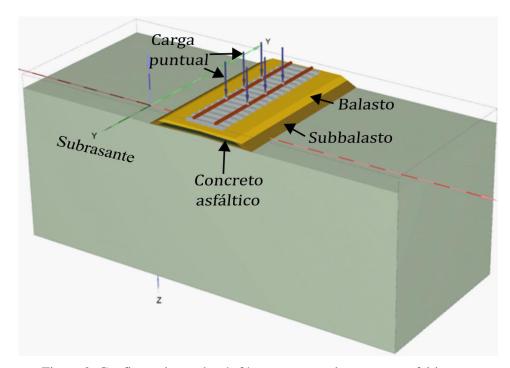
Configuraciones de vía férrea con capa de concreto asfaltico.
